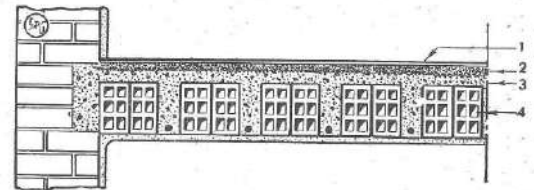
PLANCHER EN BÉTON ARMÉ ET BRIQUES CREUSES COMMUNES - 1 Sol - 2 Sous-couche - 3 Coulage du béton - 4 Briques creuses.
